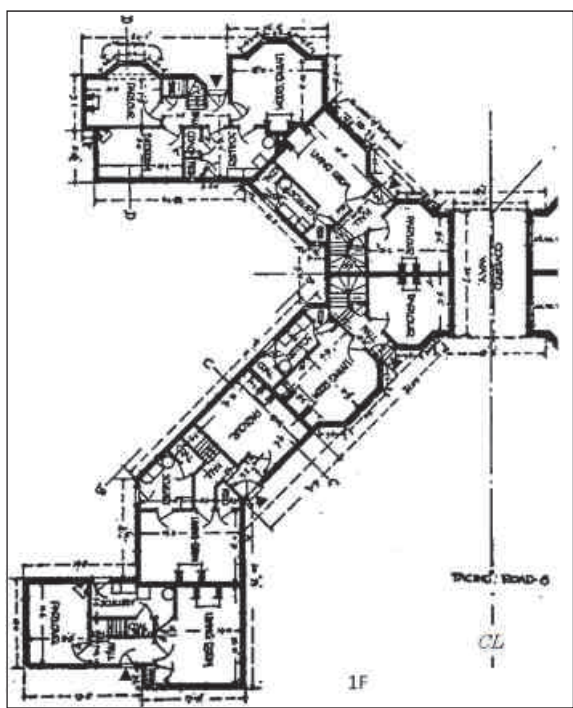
ウェル・ホール街道沿いのX型住棟1階平面図
